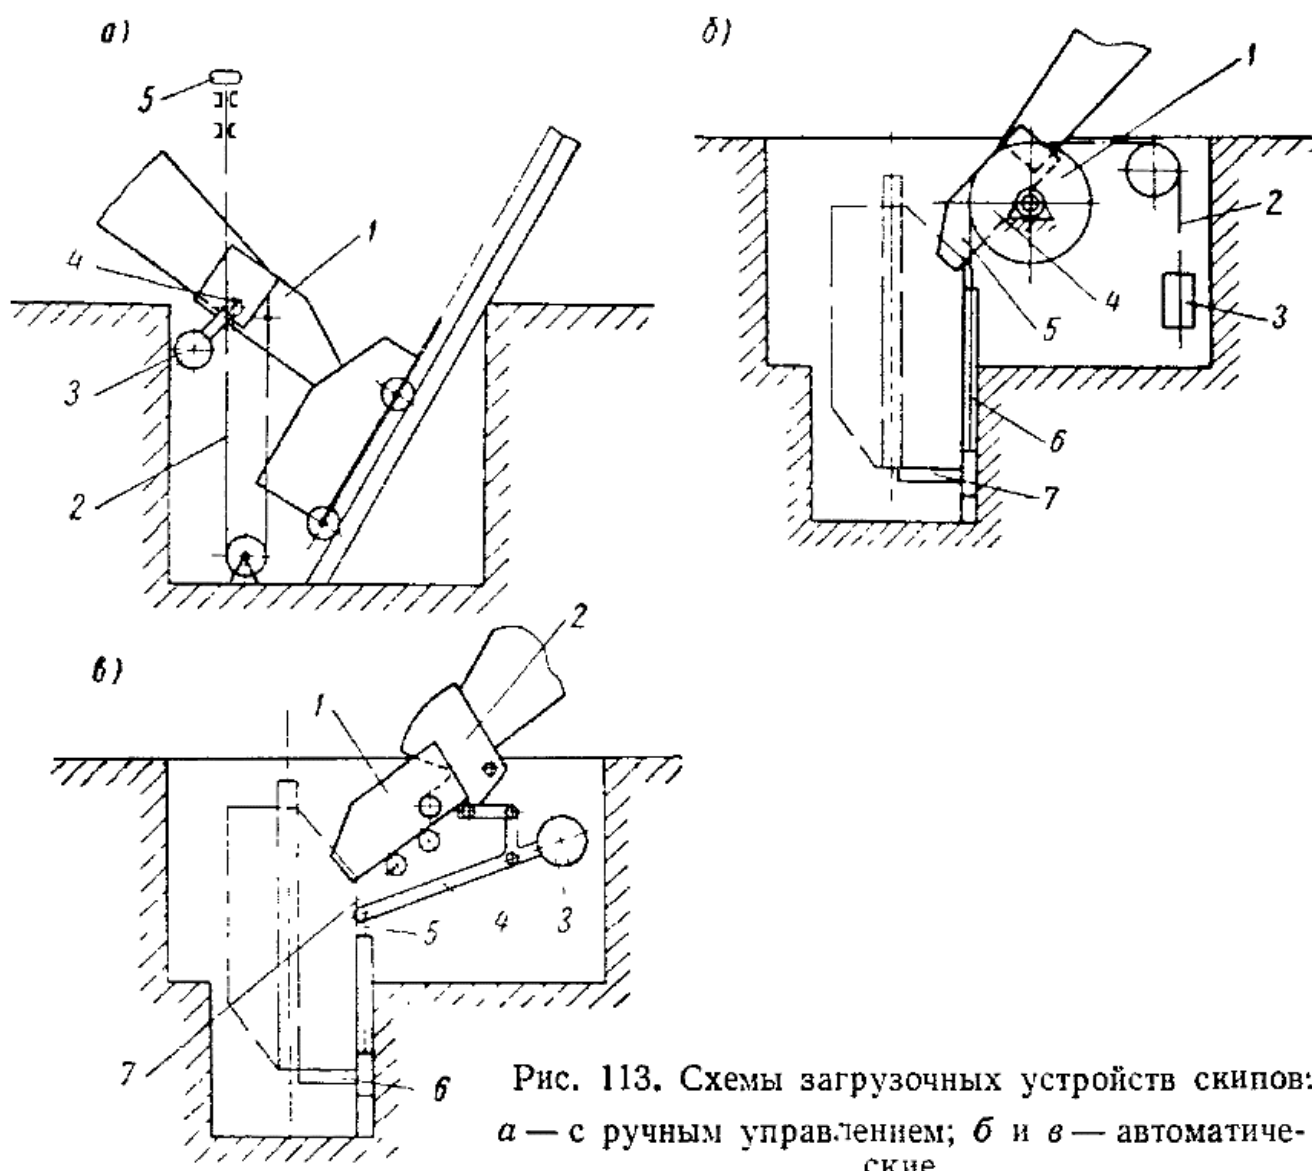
Схемы загрузочных устройств скипов: а — с ручным управлением; б и в — автоматические
